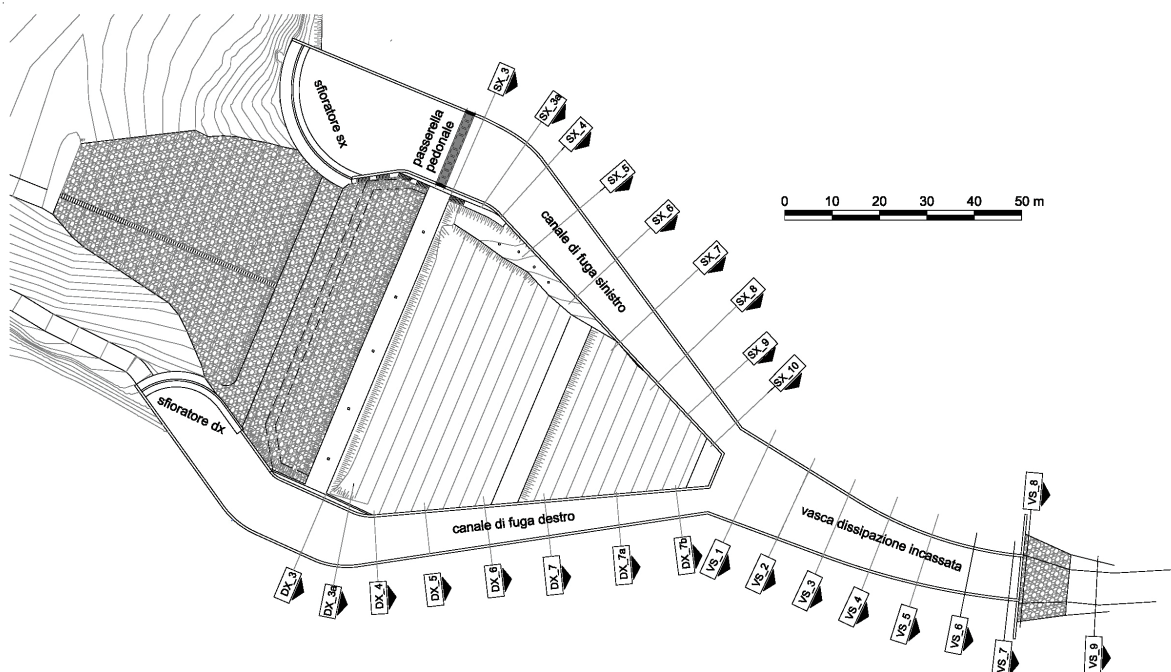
planimetria della diga nella Configurazione 3. Le sezioni significative sono posizionate come nella planimetria della Configurazione 1.
